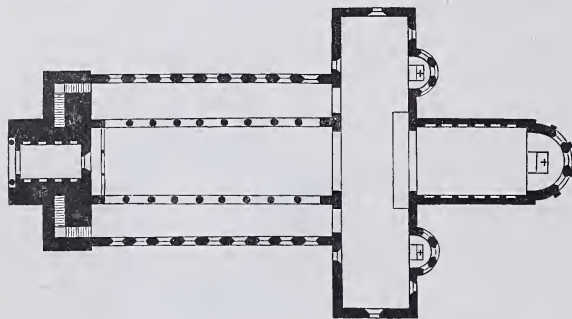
Grundriss der Klosterkirche zu Hersfeld.
